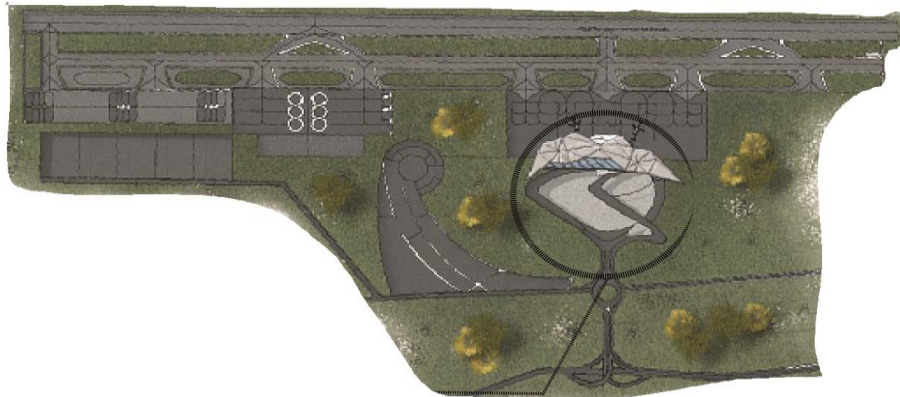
Plano desarrollo propuesta básica sketch.
